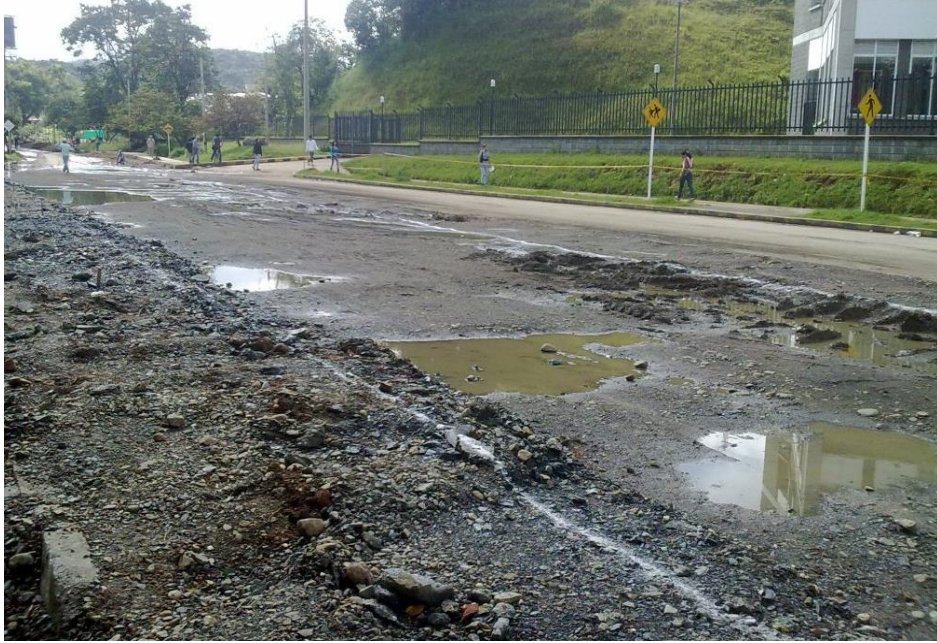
Ancho de Calzada a intervenir, demarcación con cal.
